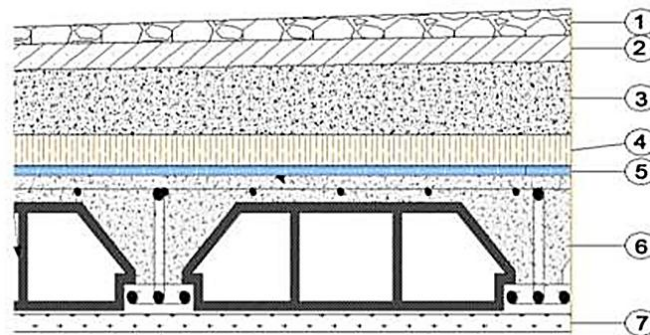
Coupe du plancher terrasse inaccessible en corps creux
